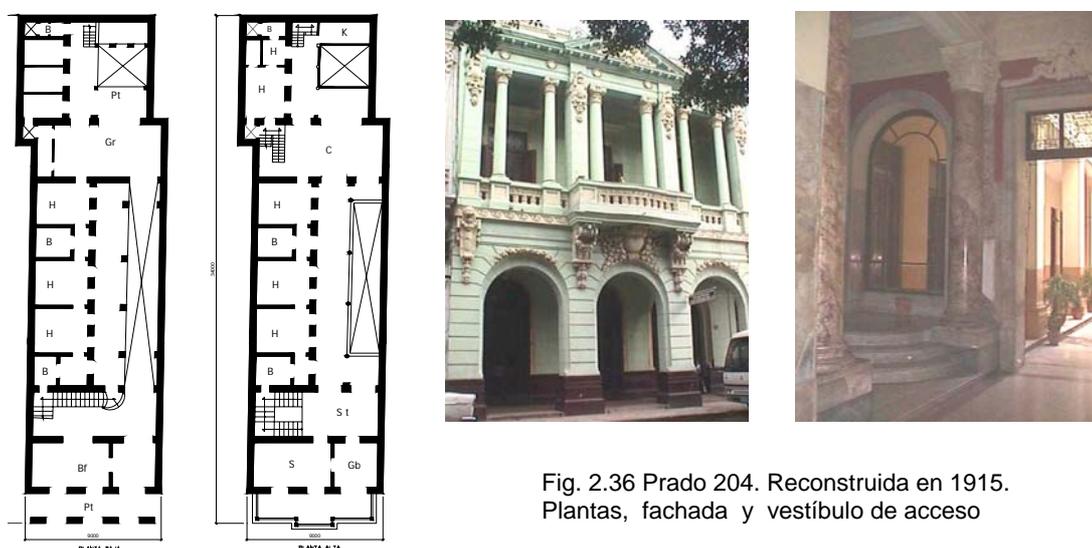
Prado 204. Reconstruida en 1915. Plantas, fachada y vestíbulo de acceso
